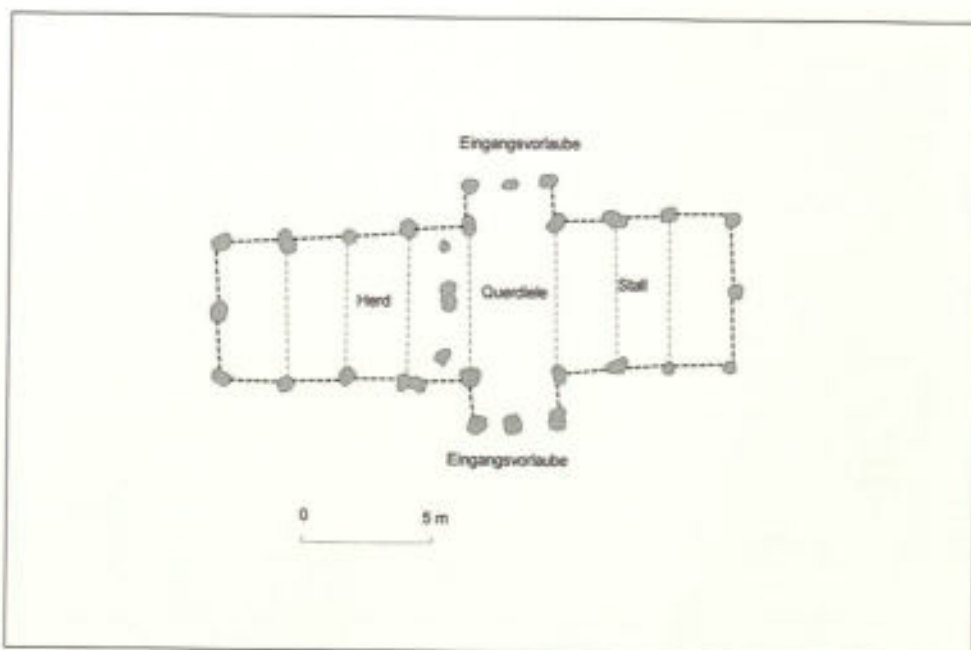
Grundriß eines traditionellen Bauernhauses aus Telgte (9. Jahrhundert)
